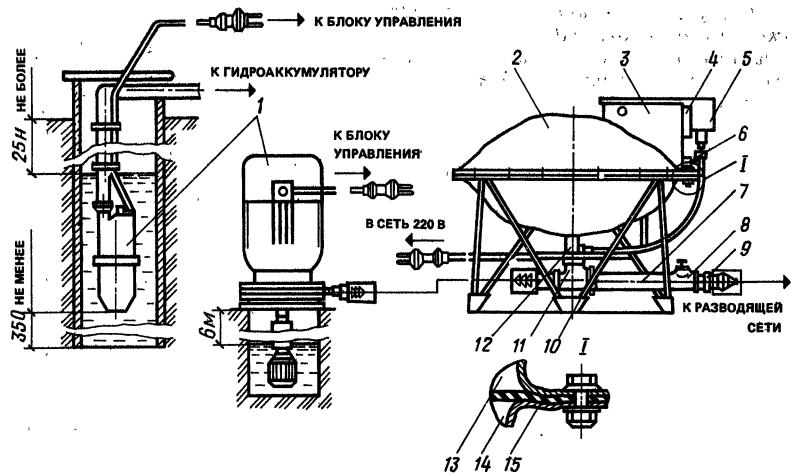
Общий вид гидропневматической водоподъемной установки
